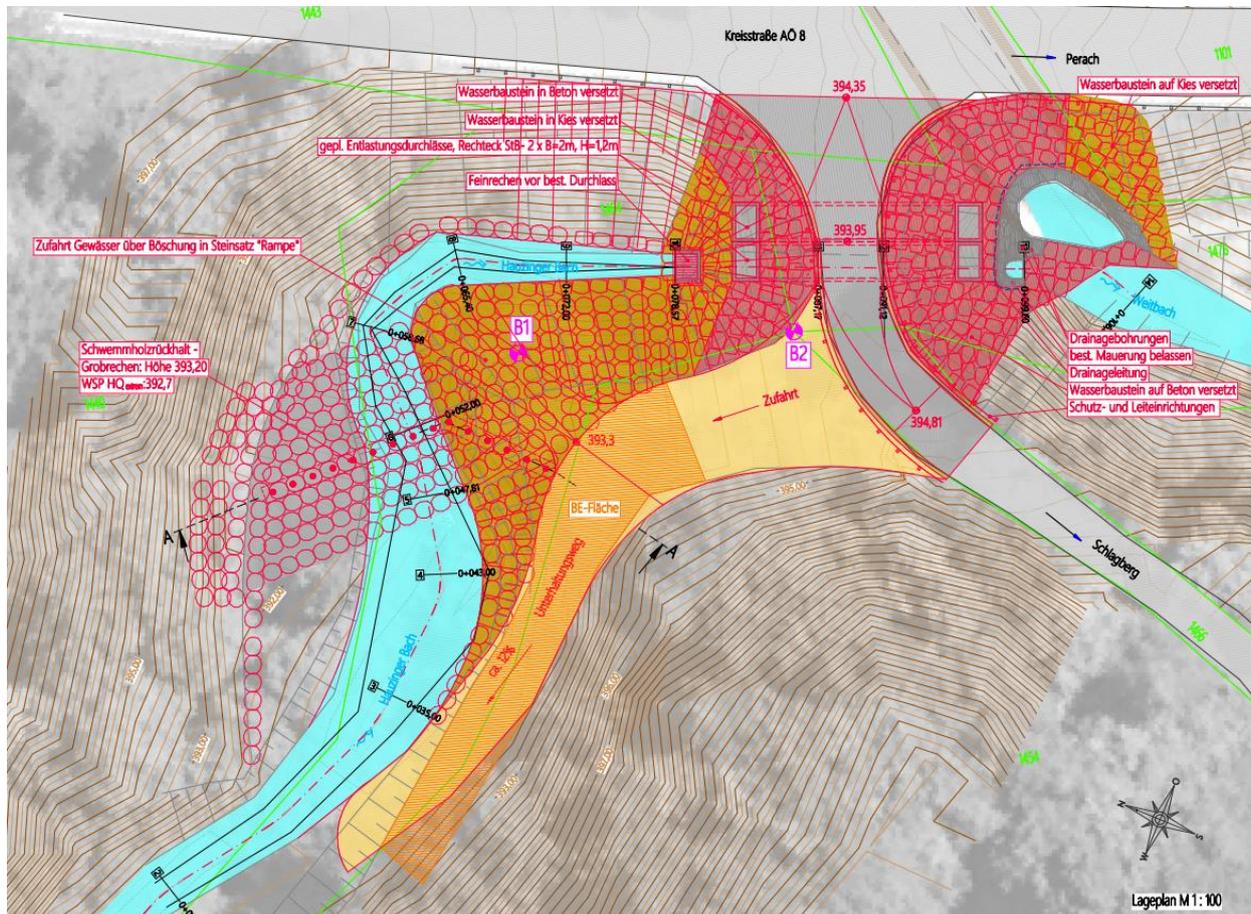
Planauszug E-DP-7.2: Lageplan Schwemmholzurückhalt – Grobrechen
